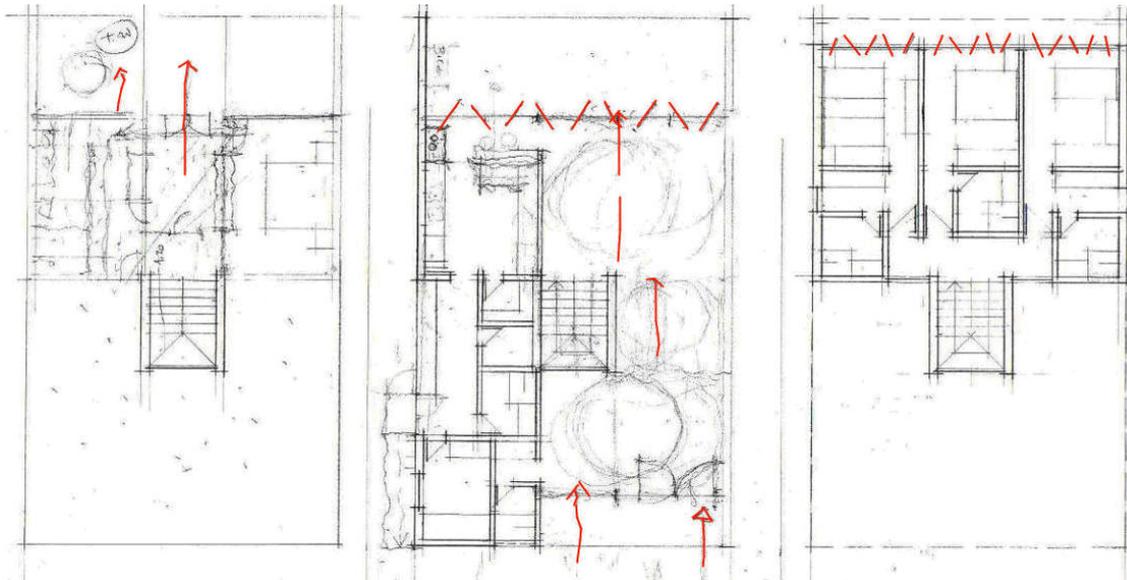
Rascunhos das plantas baixas dos três pavimentos
